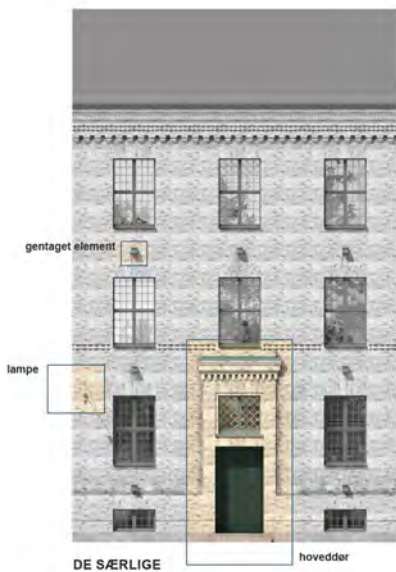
De særlige arkitektoniske facadeelementer som er kendetegnende for de eksisterende byggerier på Sankt Hans med blank mur.
